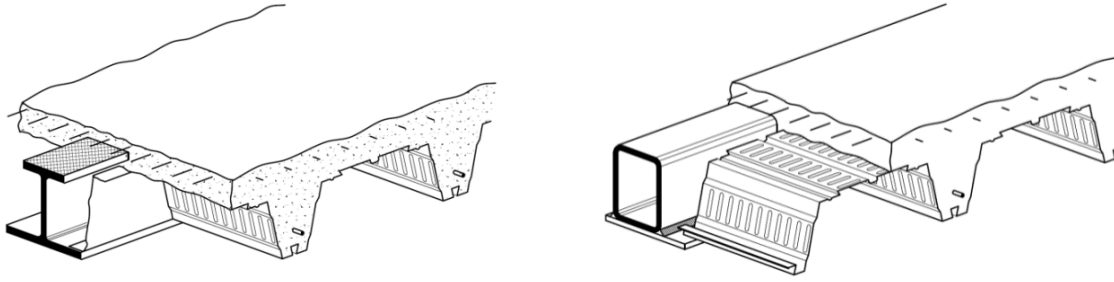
Примеры решений перекрытий пониженной высоты
